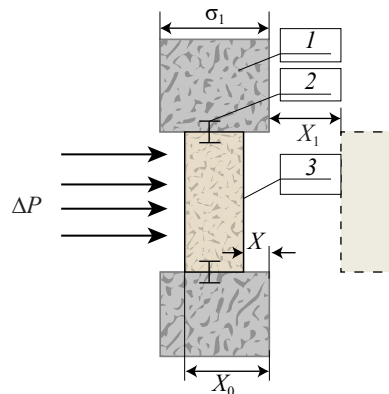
Расположение ЛСК в глубине заделки: 1 — стена здания; 2 — связь между стеной и ЛСК (узел крепления); 3 — легкобрасываемая конструкция;  $X_0$  — путь предохранительных конструкций до открытия проема
